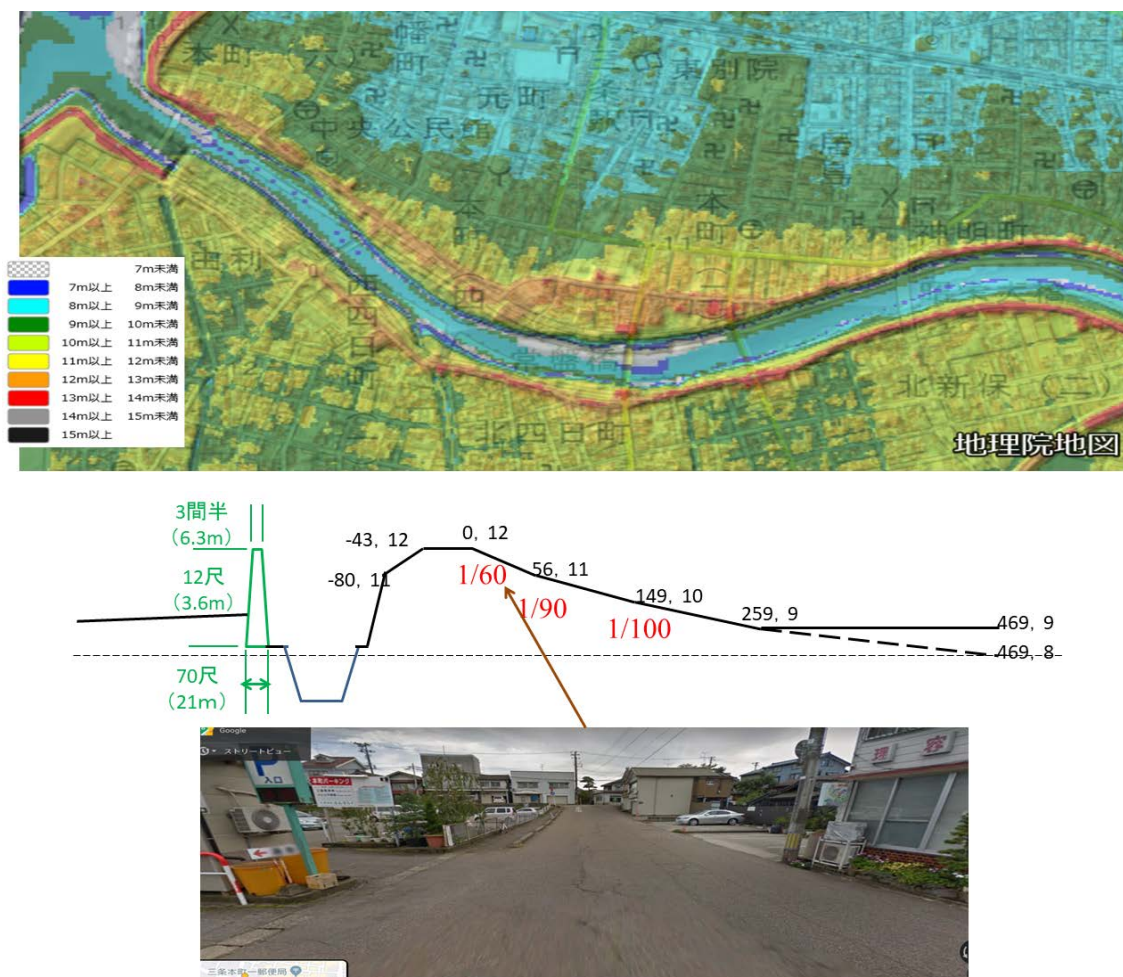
五十嵐川自然堤防と人為盛土堤防
